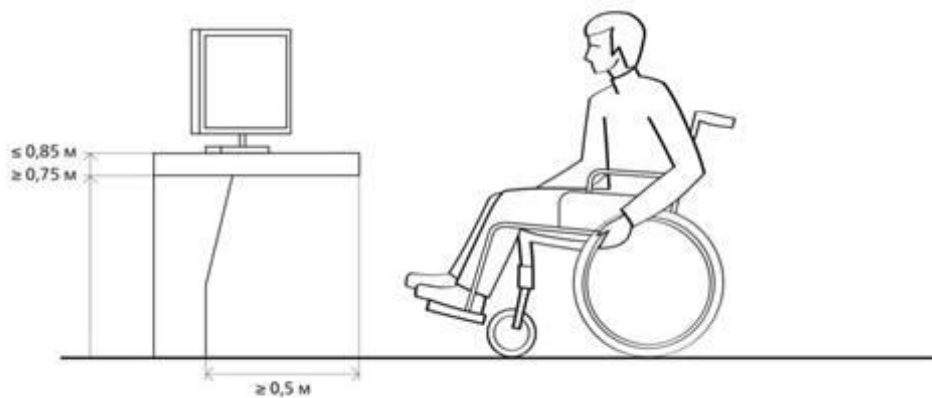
Высота рабочей поверхности для обслуживания инвалида, использующего для передвижения кресло-коляску
